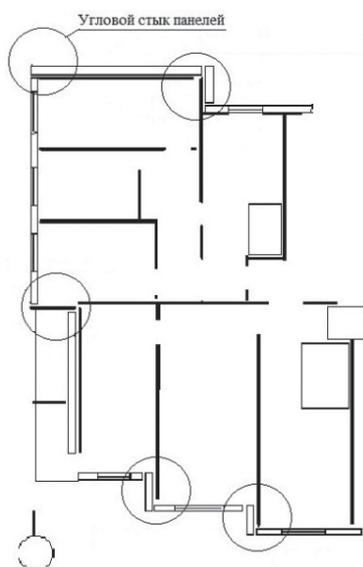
План блок-секции жилого дома из газобетонных панелей
